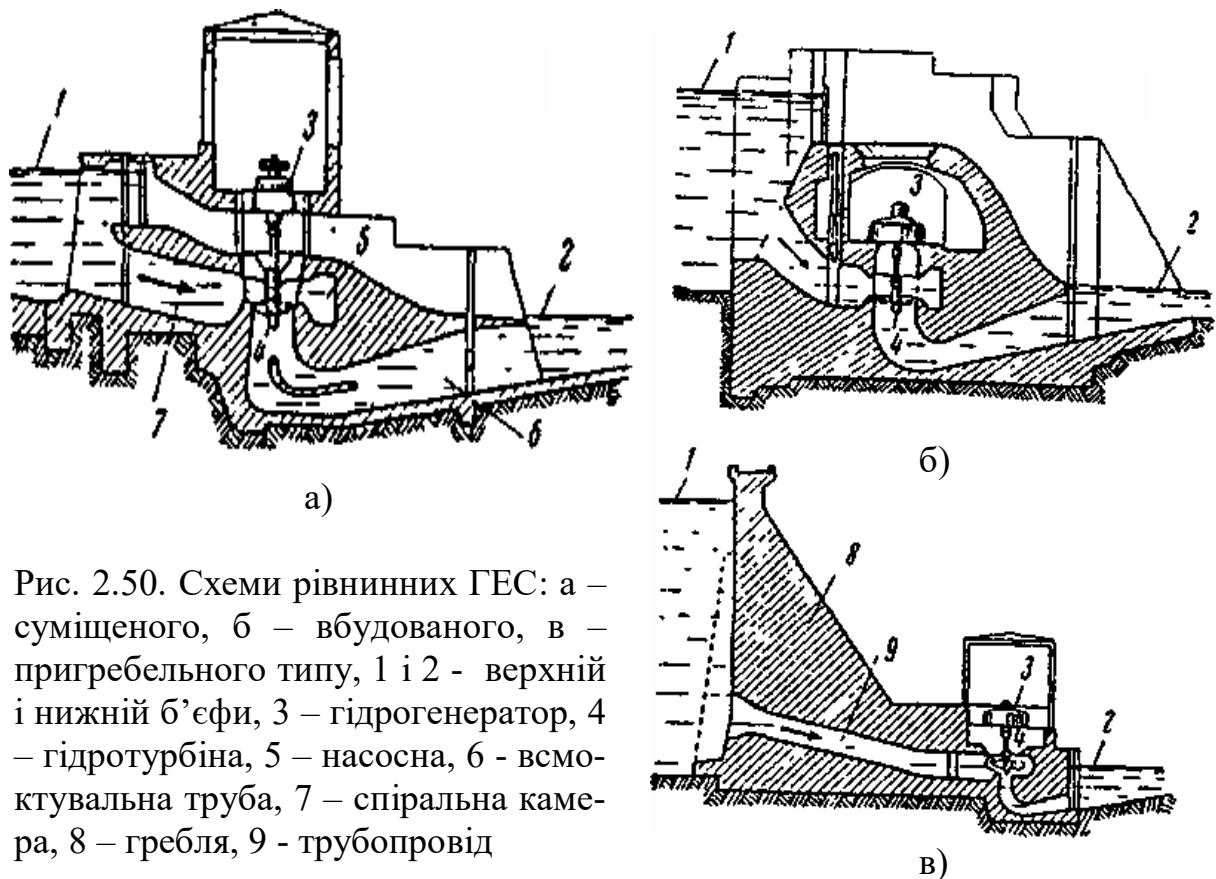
Схеми рівнинних ГЕС: а – суміщеного, б – вбудованого, в – пригребельного типу, 1 і 2 - верхній і нижній б'єфи, 3 – гідрогенератор, 4 – гідротурбіна, 5 – насосна, 6 - всмоктувальна труба, 7 – спіральна камера, 8 – гребля, 9 - трубопровід
